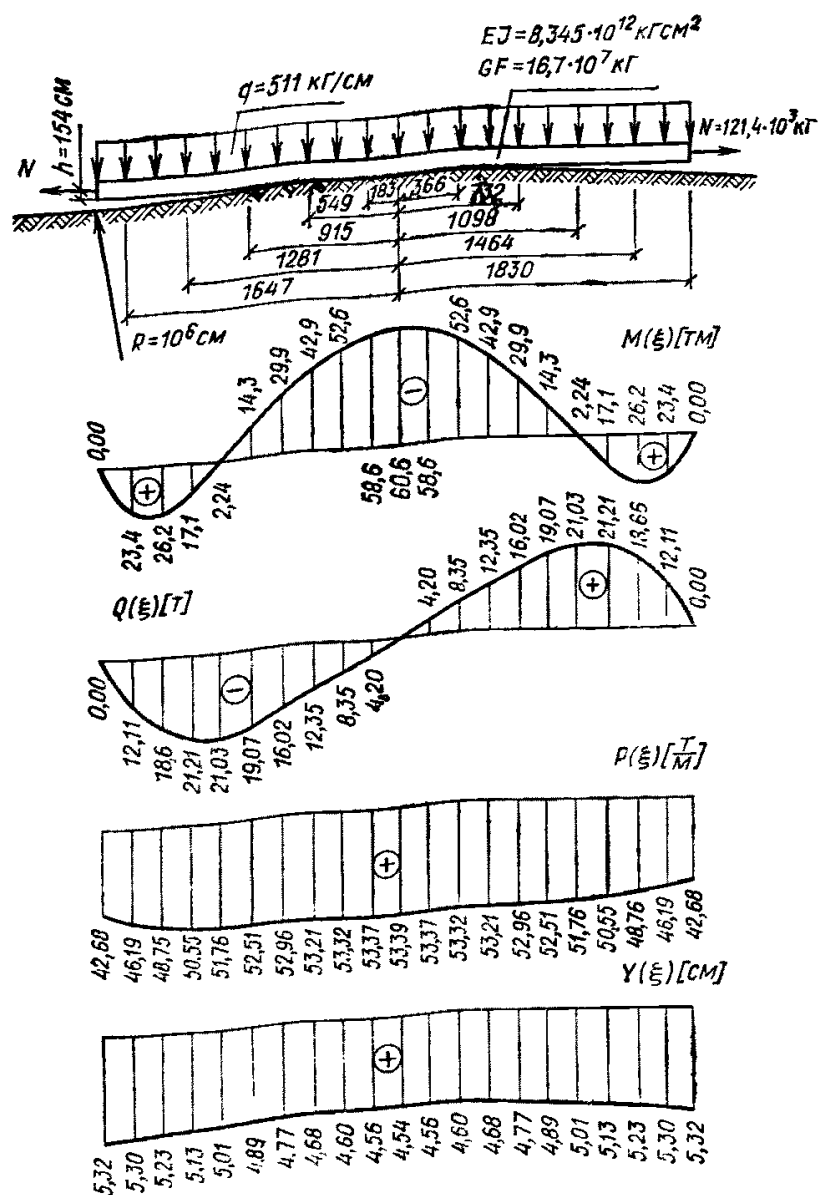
Расчетная схема здания и эпюры изгибающих моментов поперечных сил, отпора грунта и изгиба здания
